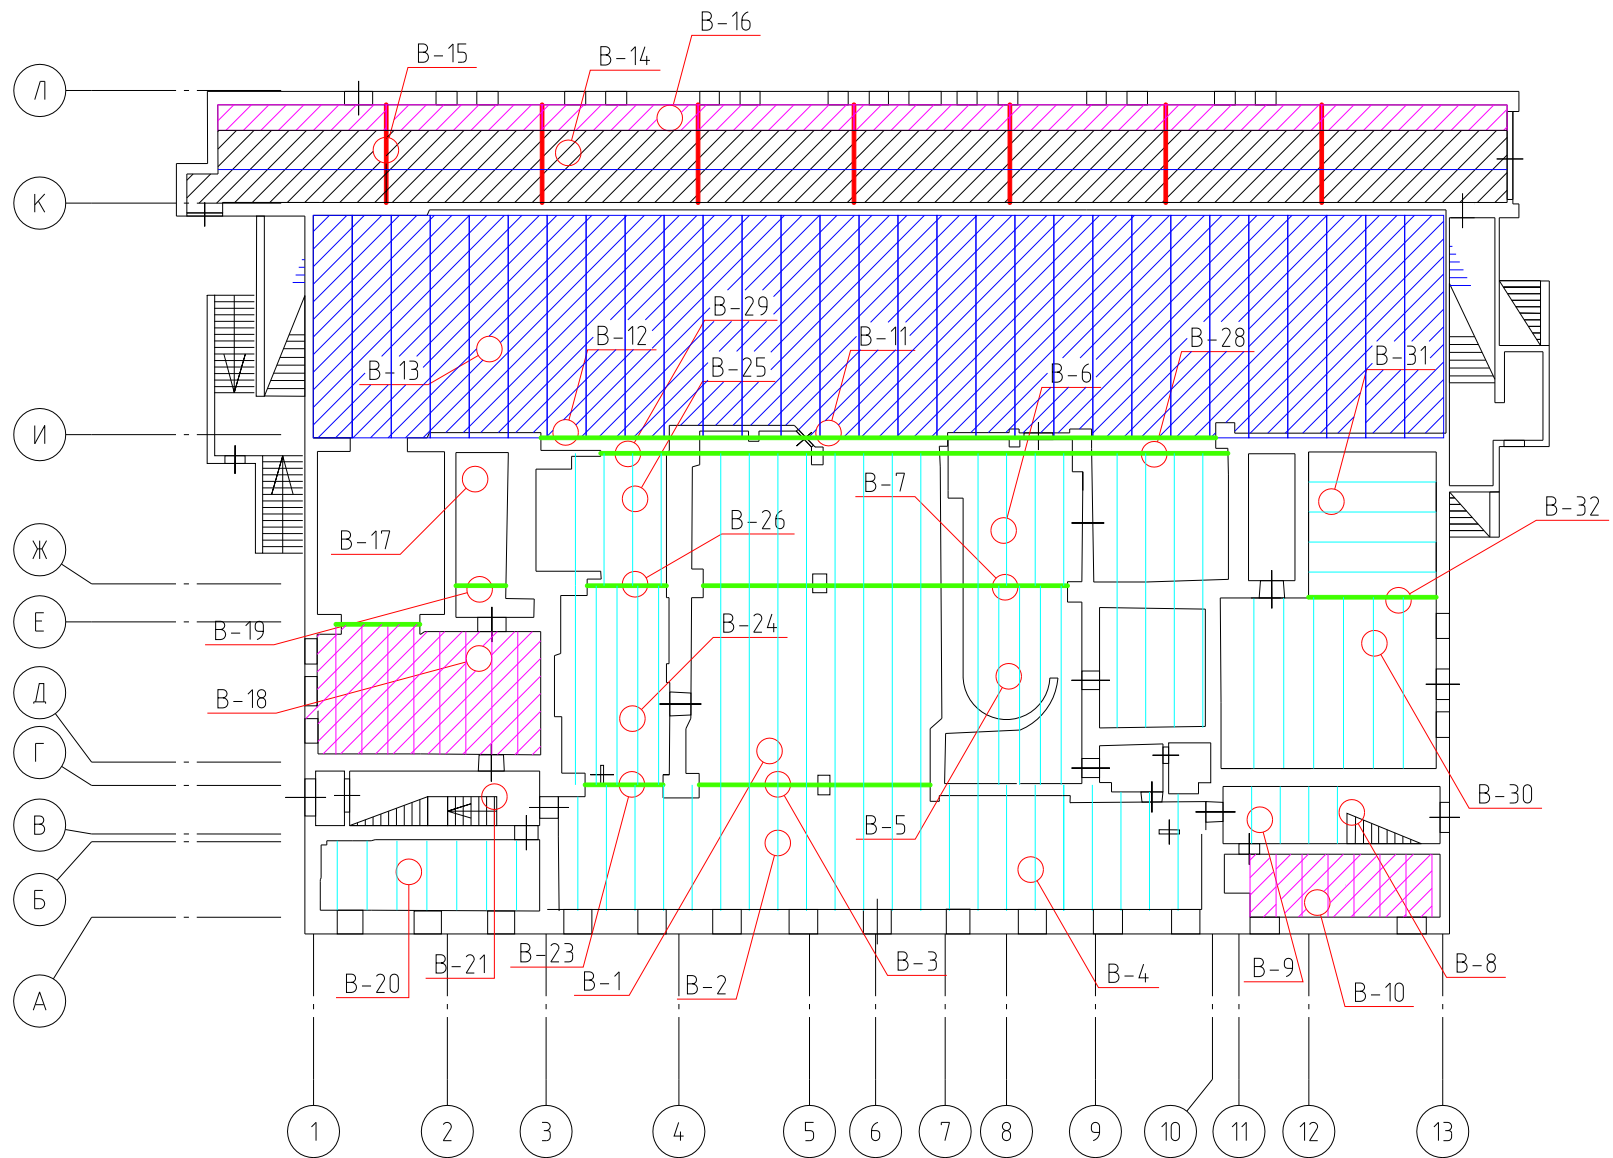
Схема участков вскрытий над первым этажом с раскладкой плит и балок.
